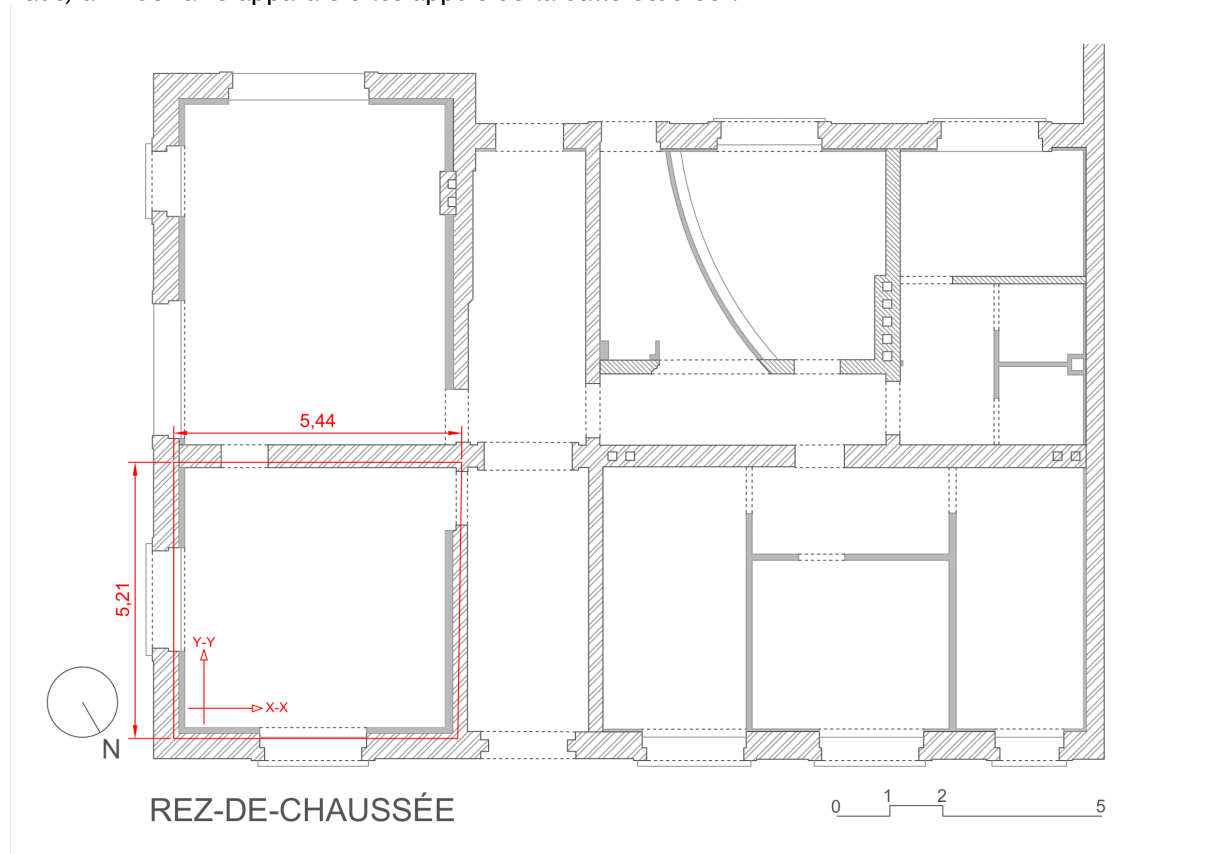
Plan du plancher étudié - ici plancher haut du RDC - local de l'angle nord-est.
